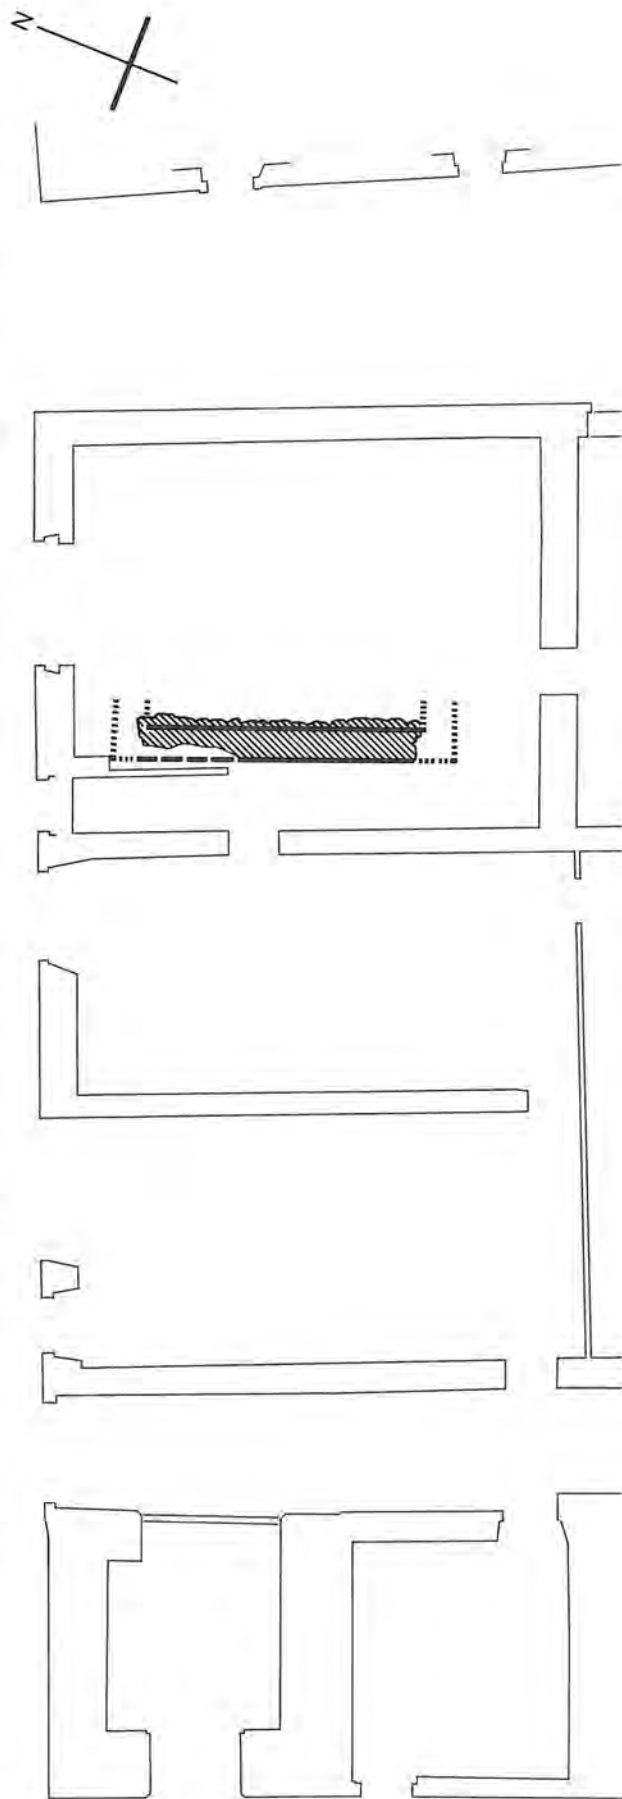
Plan schématique d'un premier bâtiment issu du premier chantier, éch.: 1:150.
